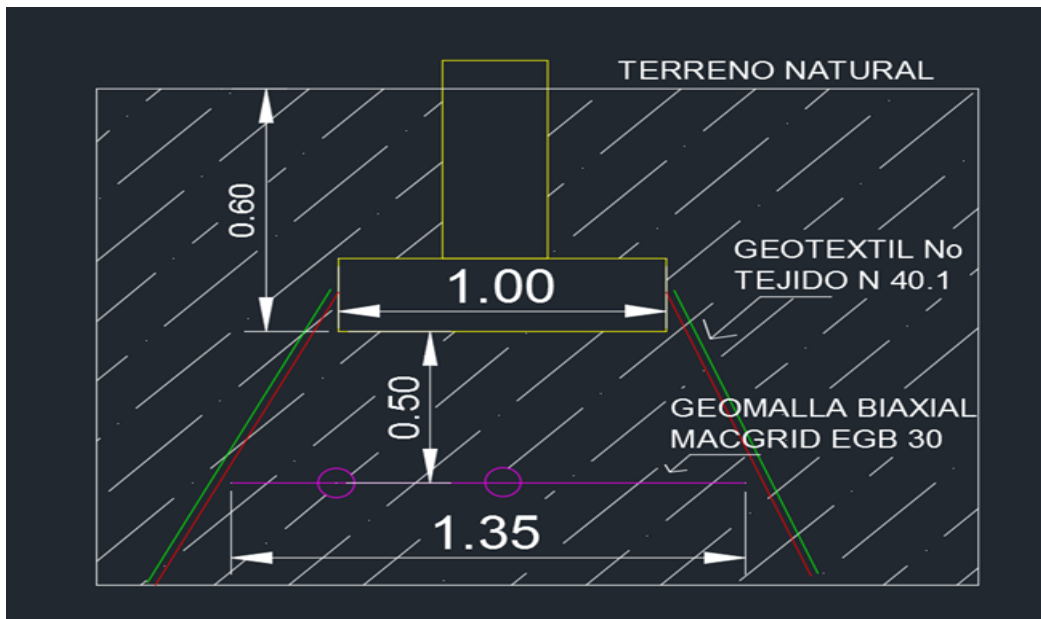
Diseño de cimentación con refuerzo de geomallas para zapata N°4
